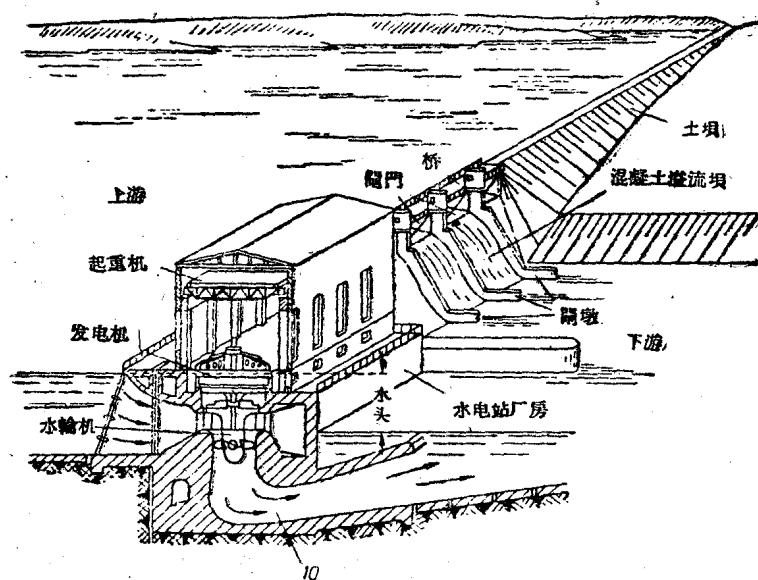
混凝土坝中型河床式水电站建筑物示意图
